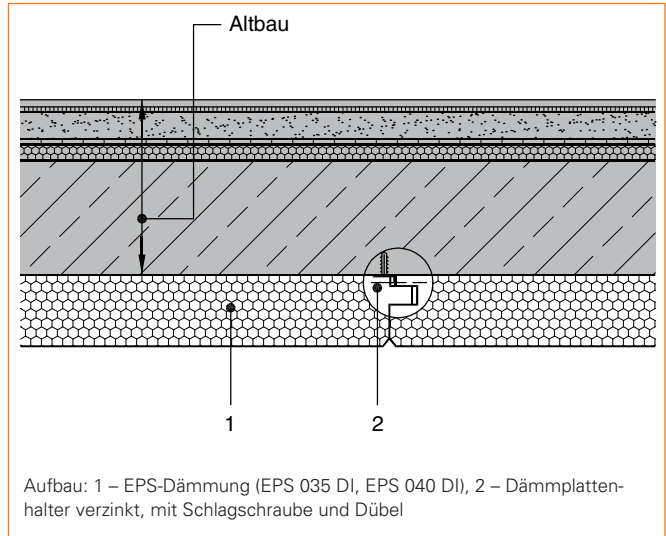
Sanierungsvariante: Kellerdecke mit unterseitiger Wärmedämmung
